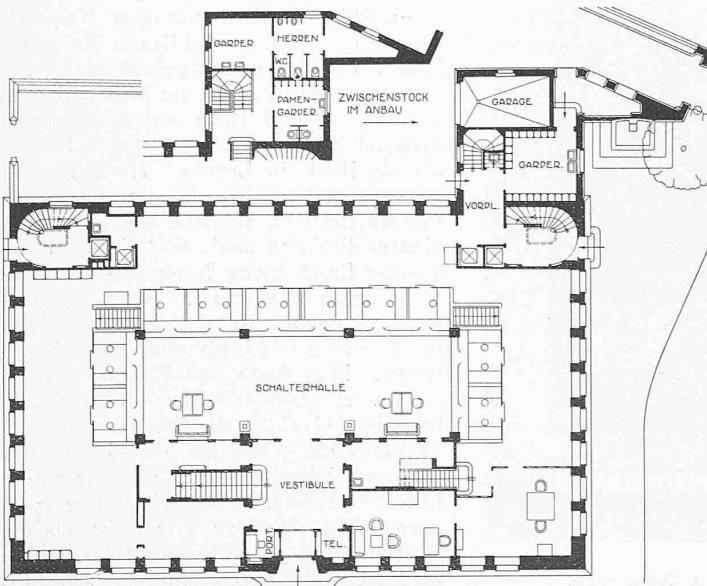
(links). Grundriss des Erdgeschosses. — 1 : 400.
